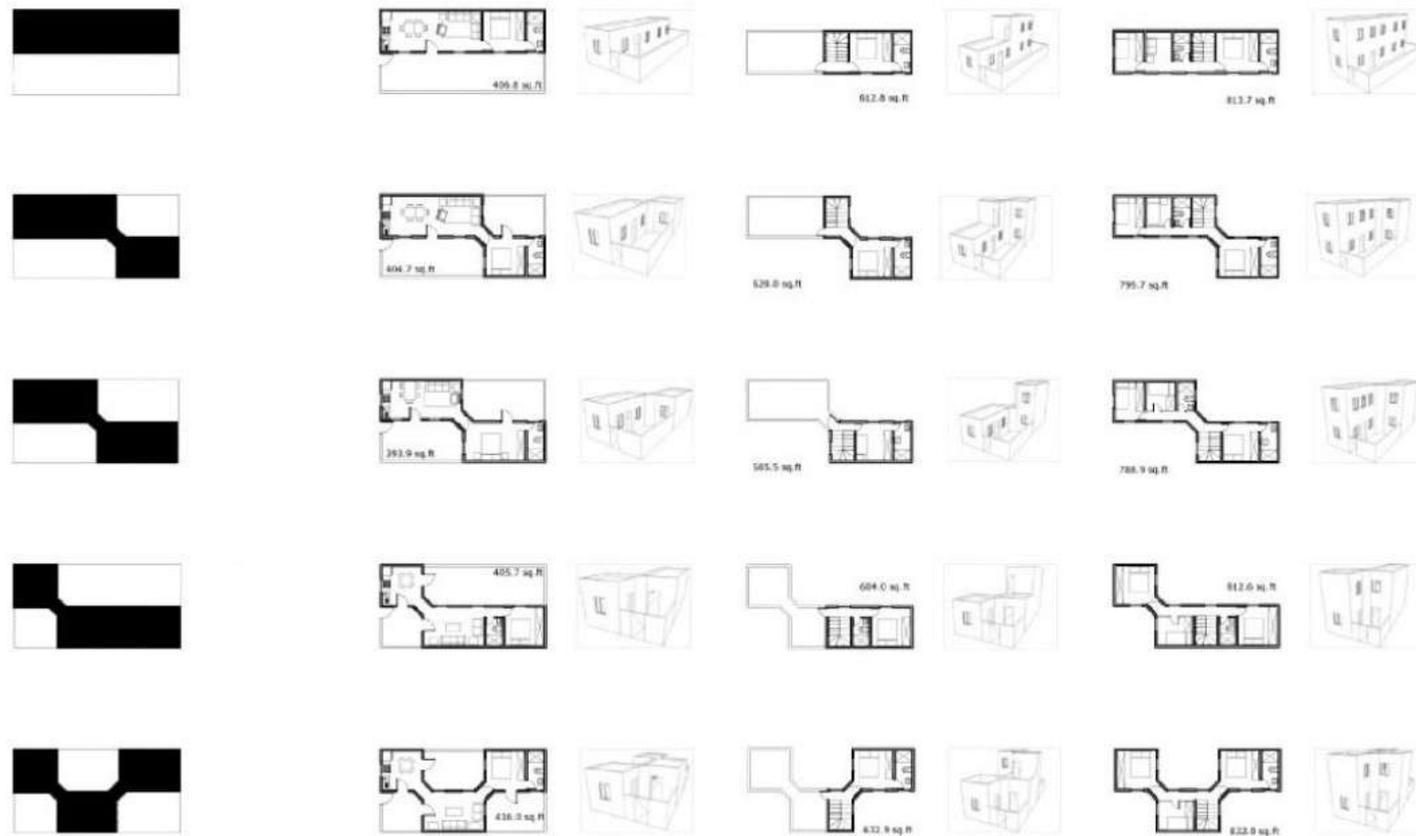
Diagrama de Noll y planta arquitectónica de las viviendas. Dellekamp Arquitectos + Gerardo Asaldi <https://dellekamparq.com/?p=304> (01-Enero-2017)
